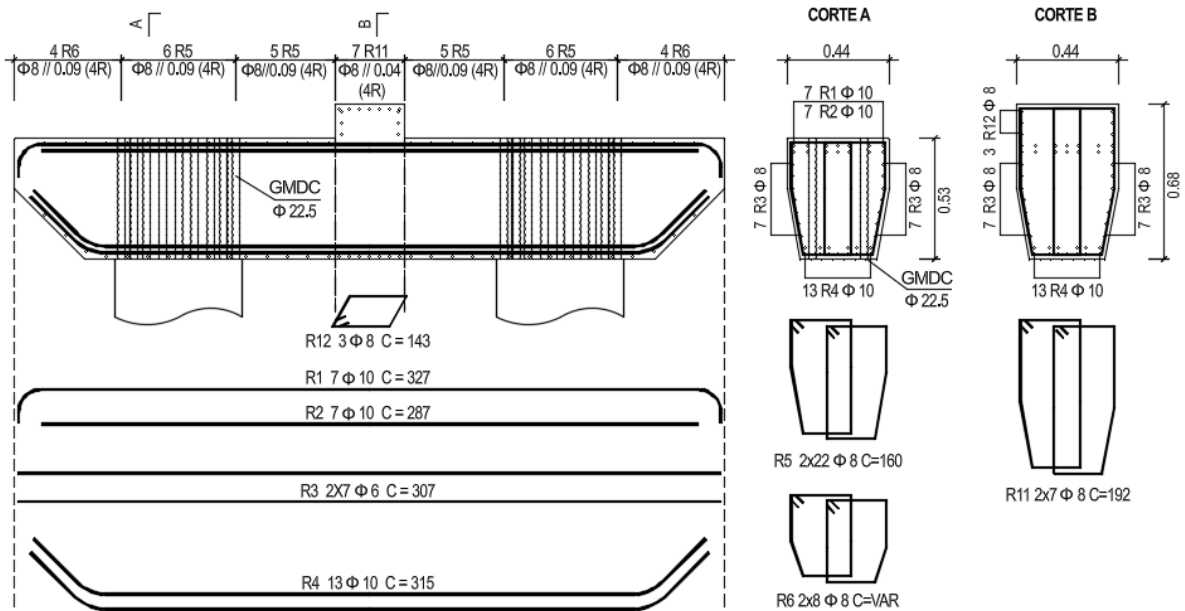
Layout de armaduras da travessa e dos nós pilar-travessa do protótipo PE0.
